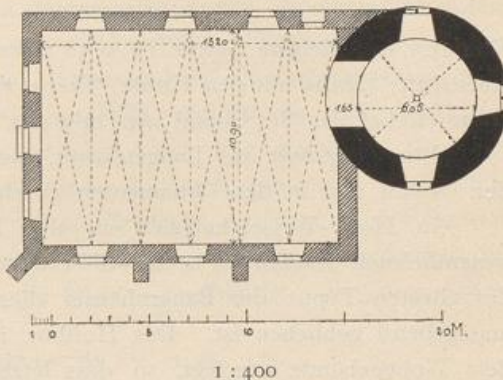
Hoch-Weisel. Grundriss der Kirche.
